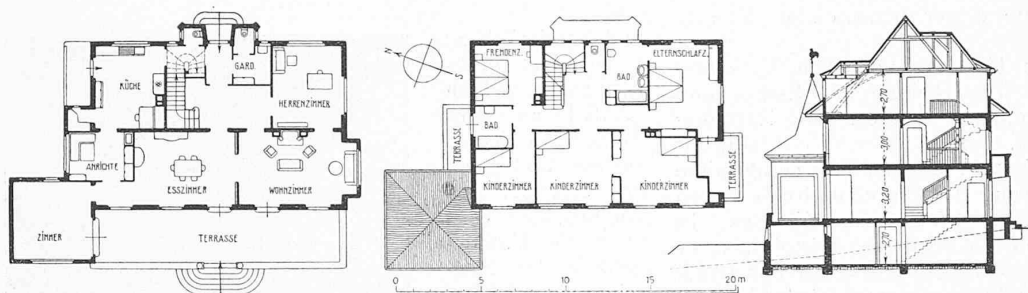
bis 7. Landhaus R. Naef in Erlenbach bei Zürich. — Grundrisse und Schnitt 1 : 400.
